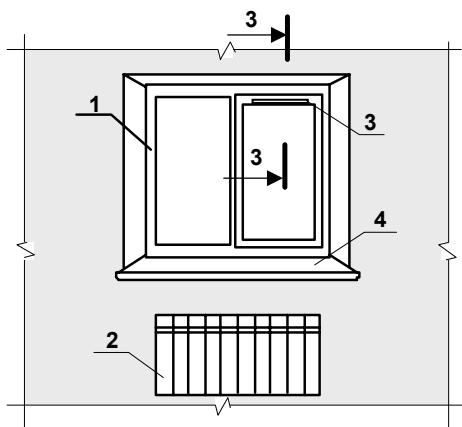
Принципиальная схема монтажа оконного вентиляционного клапана (1 – оконный блок; 2 – отопительный прибор; 3 – оконный вентиляционный клапан; 4 – подоконник; 5 – монтажная планка; 6 – наружный козырек)
